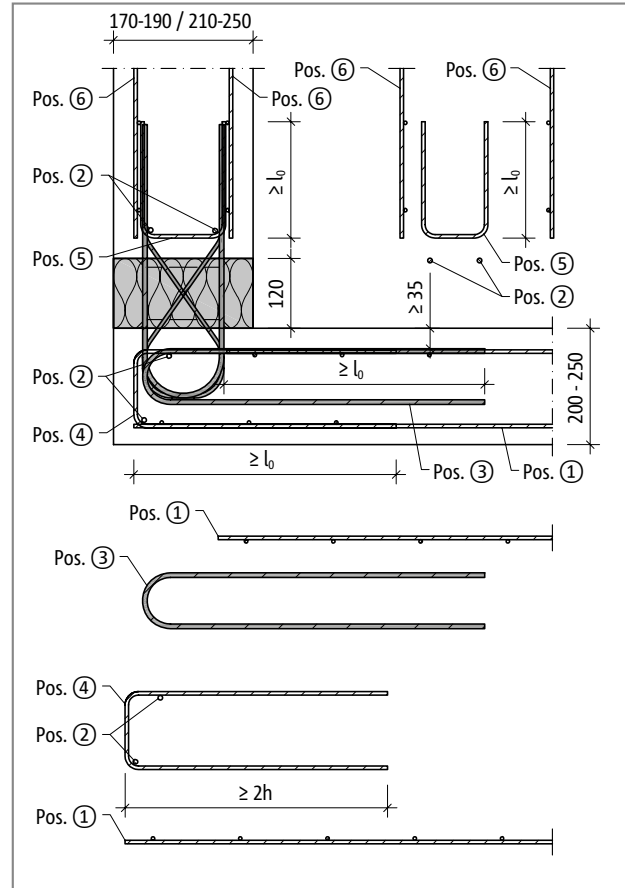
Schöck Isokorb® XT Typ A: Bauseitige Bewehrung außenliegend (B = 170 - 190 und B = 210 - 250)
